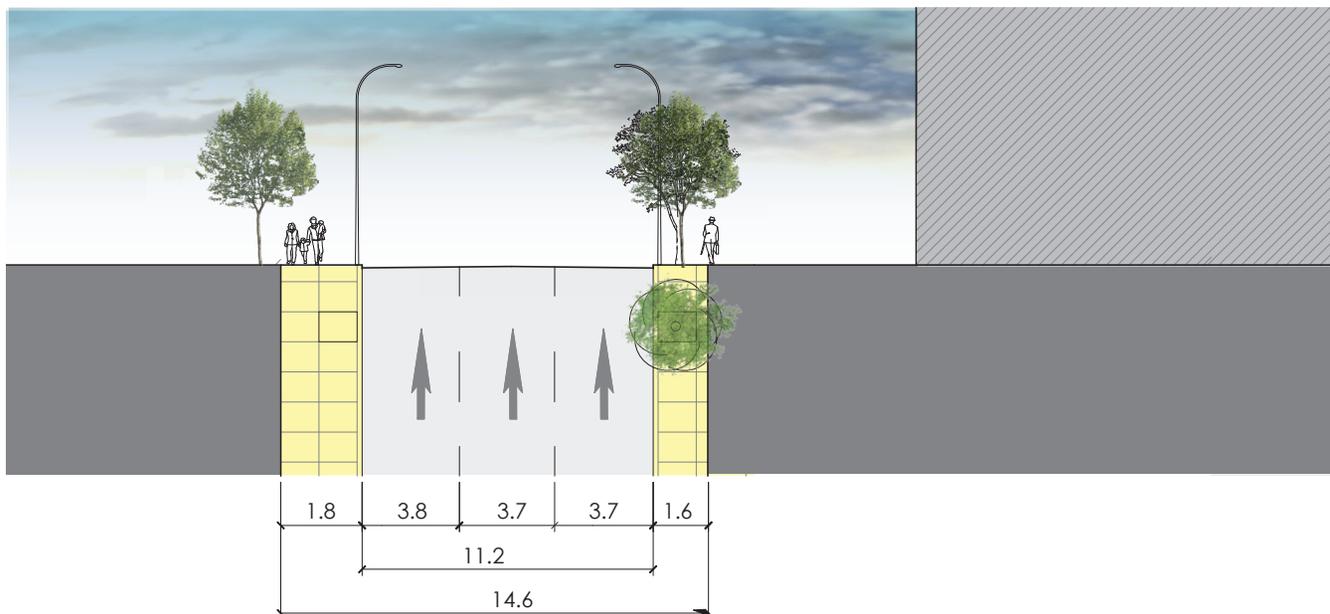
Coupe A1-A1', existant - rue de Castelnau O entre Saint-Laurent et Clark, échelle 1:300
